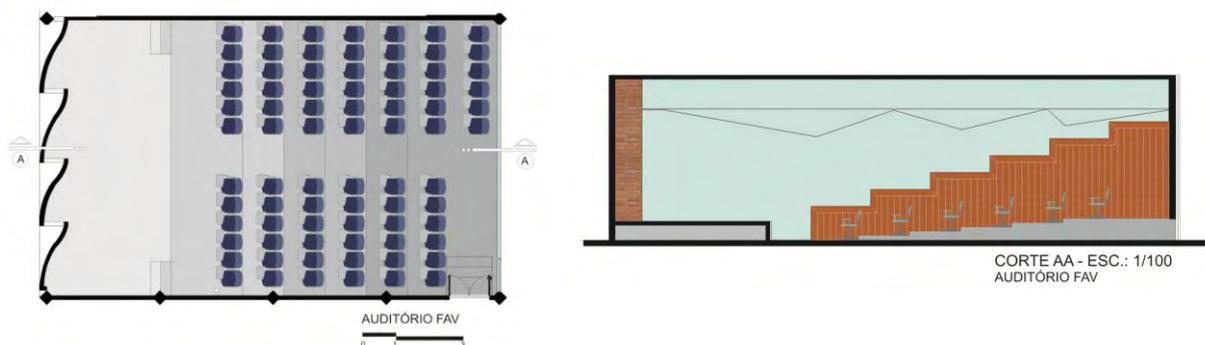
Planta e corte do mini-auditório da Fav. Adaptado arquivo Cegef
